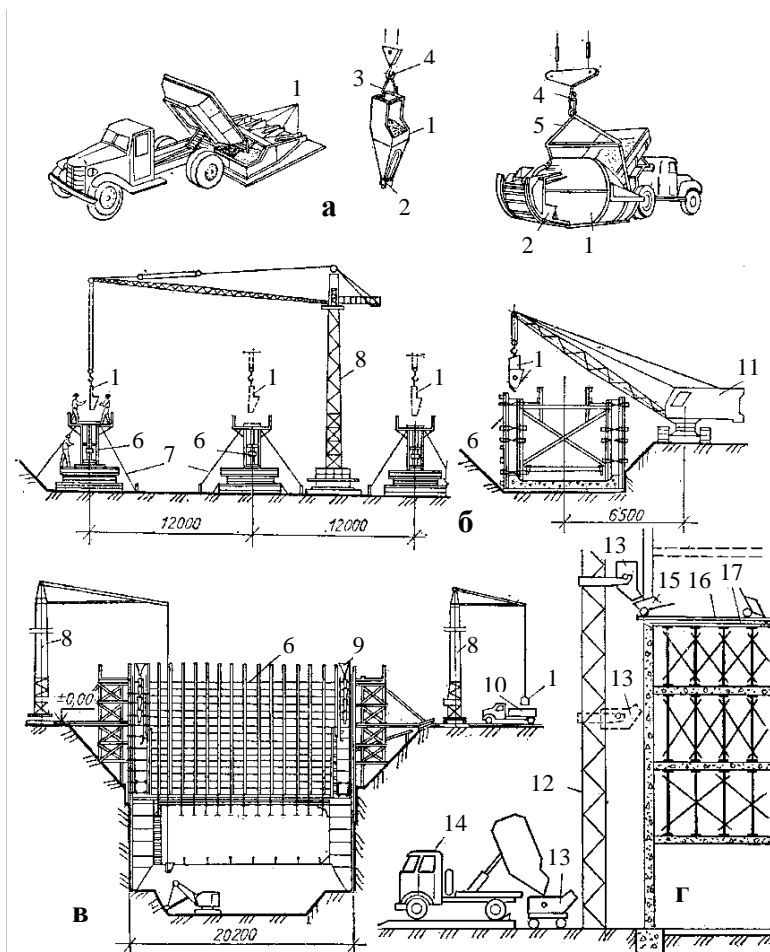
Схеми подавання бетонної суміші кранами і підйомниками: а – завантаження цебер; б – бетонування фундаментів у разі розташування крана всередині й на брівці котловану; в – бетонування стінок опускного колодязя; г – використання підйомника для подавання бетонної суміші; 1 – цебро; 2 – затвор; 3, 5 – підвіски; 4 – гак крана; 6 – опалубка; 7 – розпірки; 8 – крани; 9 – воронка ланкового хобота; 10 – автобетоновіз; 11 – гусеничний кран; 12 – підйомник; 13 – роздавальний бункер; 14 – самоскид; 15 – тачка; 16 – качальні ходи; 17 – бетоновані перекриття
